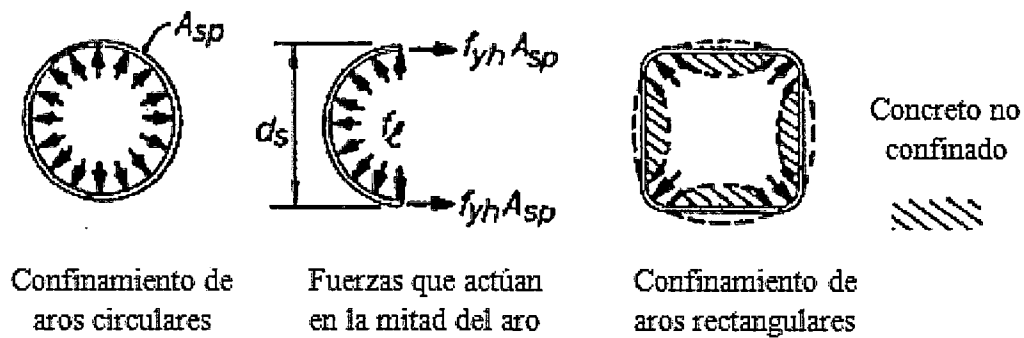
Presión de confinamiento en el concreto en la columna. (a) Columna circular con zuncho helicoidal. (b) Columna con estribo rectangular.
